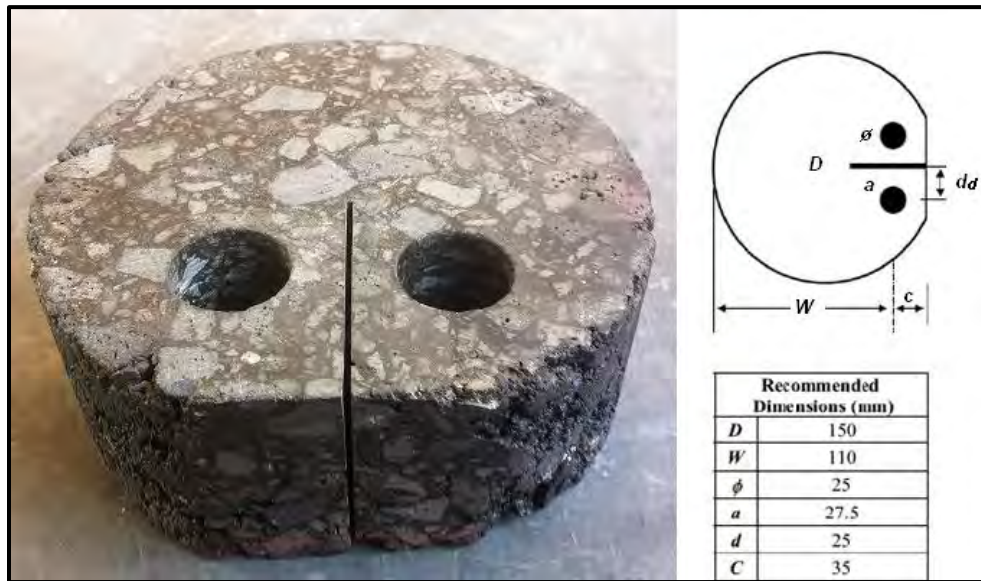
Dimensiones recomendadas para las probetas de la prueba de fractura.
